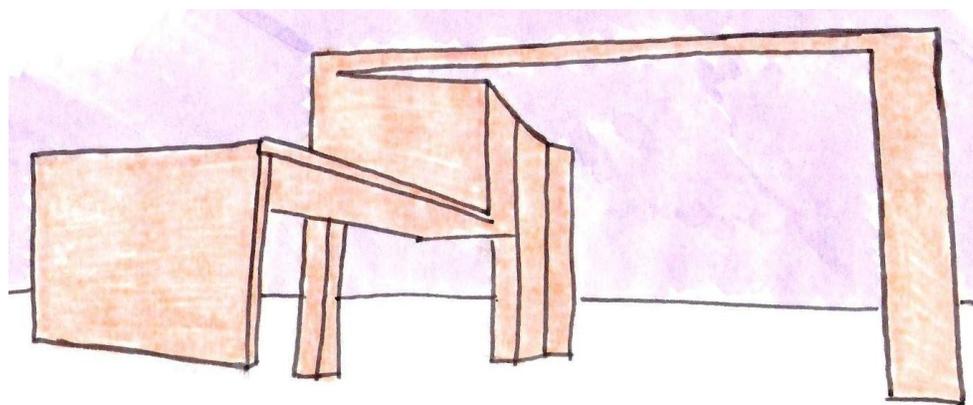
Croqui da fachada posterior Casa Braga
